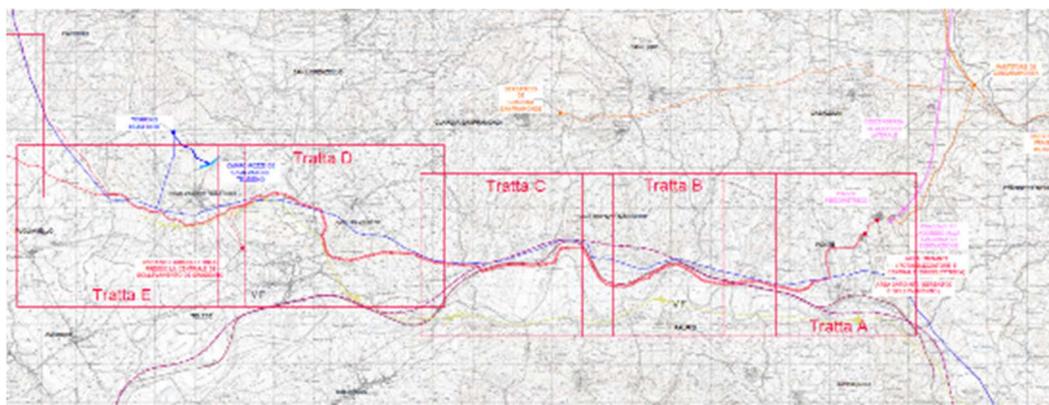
Planimetria condotta adduzione ACAM (in rosso)
